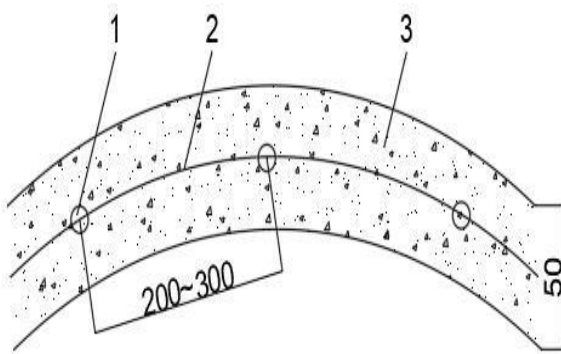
贴嘴注浆布孔示意图 (单位: mm)
